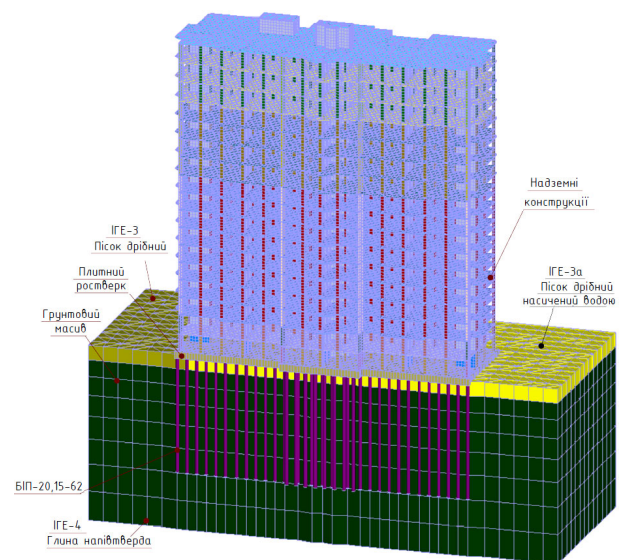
Скінчено-елементна модель системи «ґрунтова основа – фундамент – будівля»
